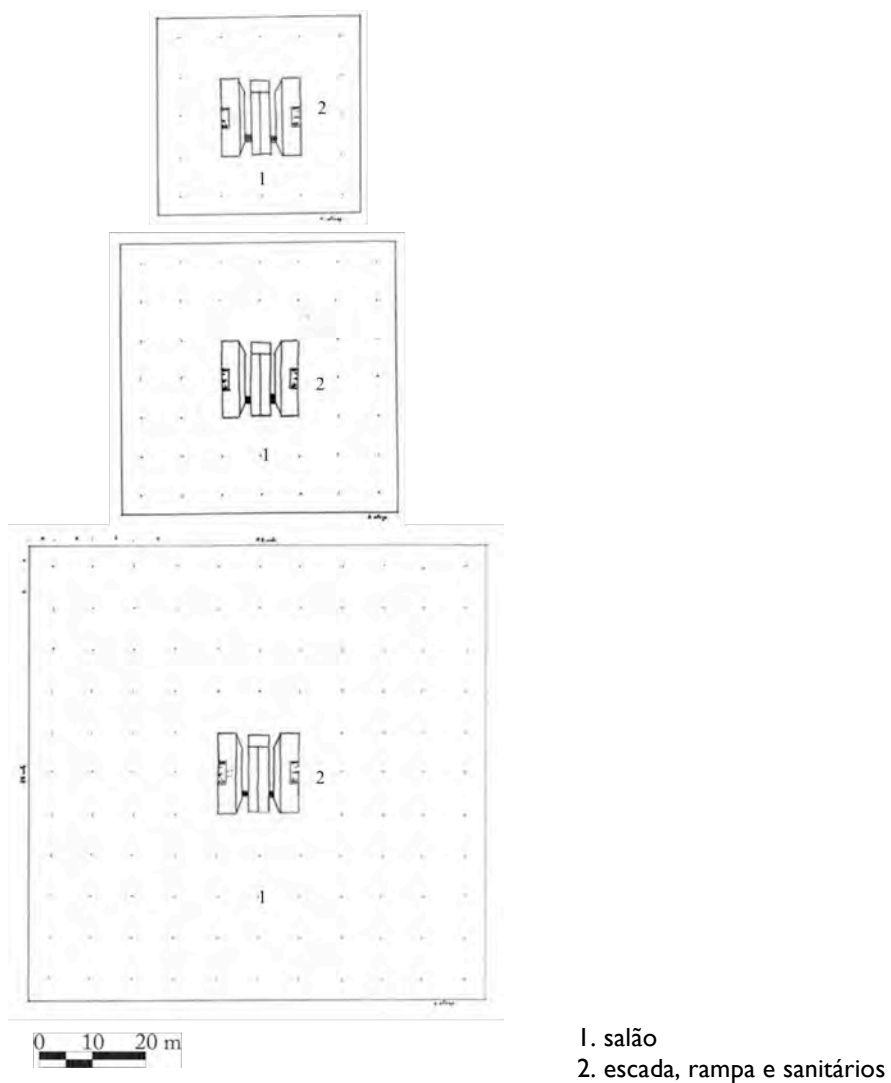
Museu da Terra (1974) – pavimentos – planta baixa.
